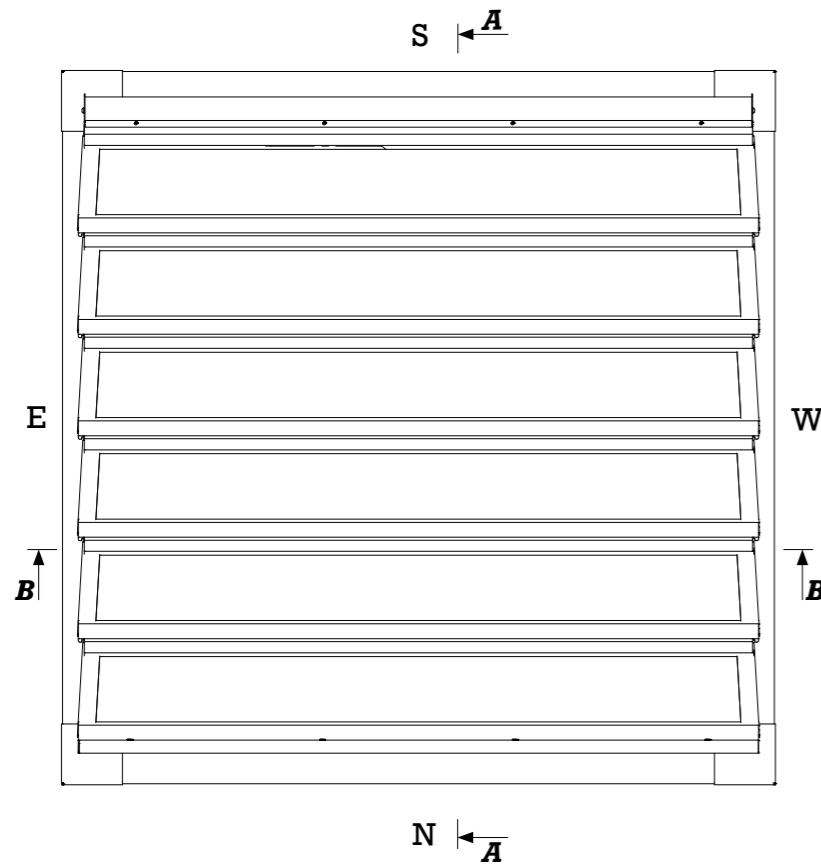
Draufsicht von einem Lamellenlüfter mcr LAM in geschlossener Position (Fassadeneinbau)
